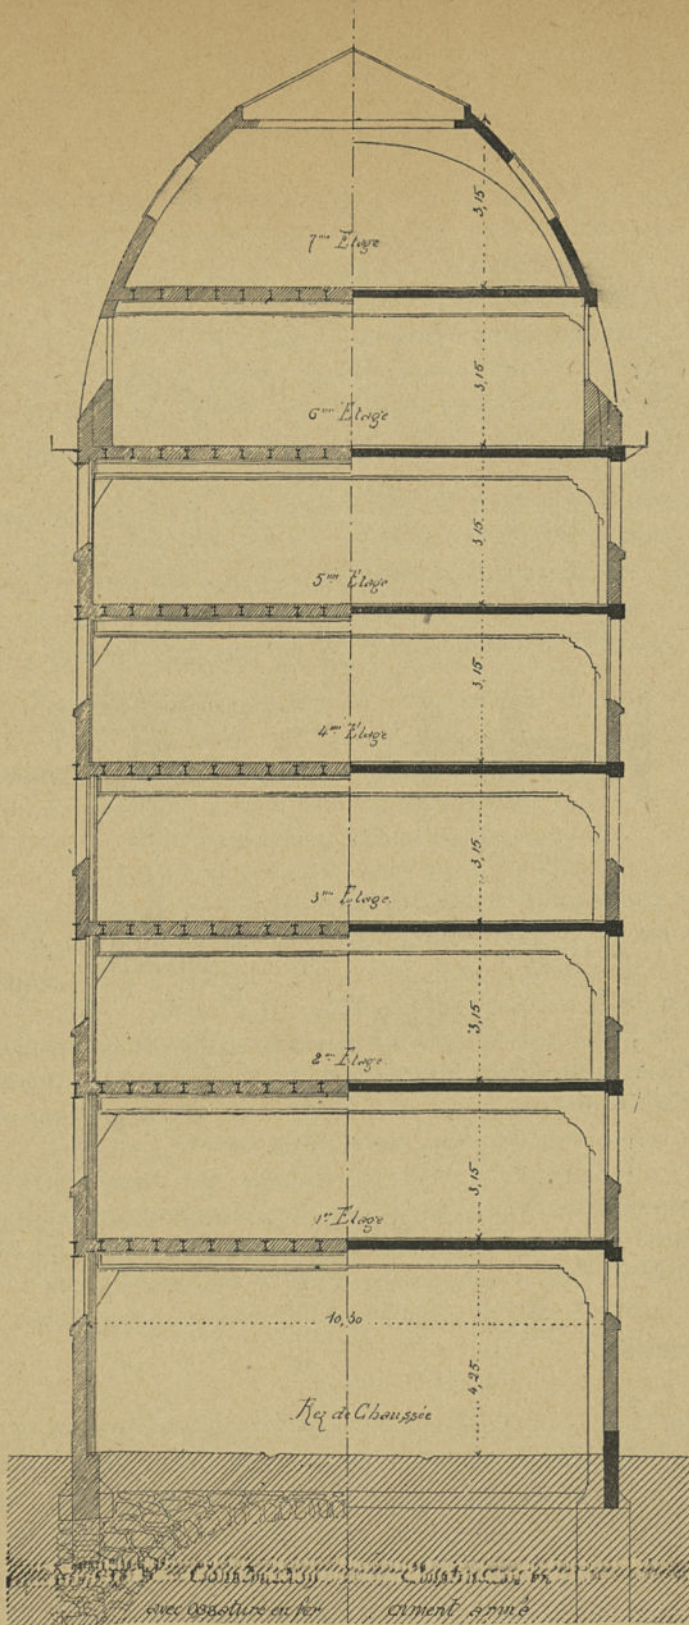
Construction à l'usage d'atelier. Coupe d'une travée.
